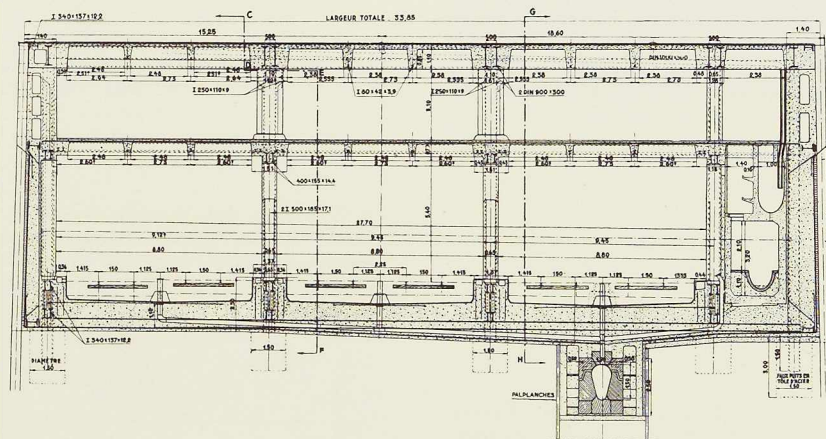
Coupe transversale du tunnel de la Jonction Nord-Midi, à Bruxelles.
